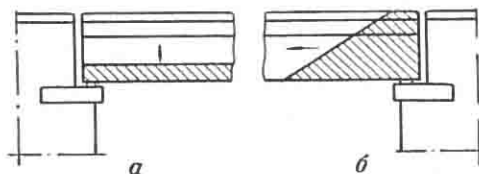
Последовательность бетонирования балочных пролетных строений:
